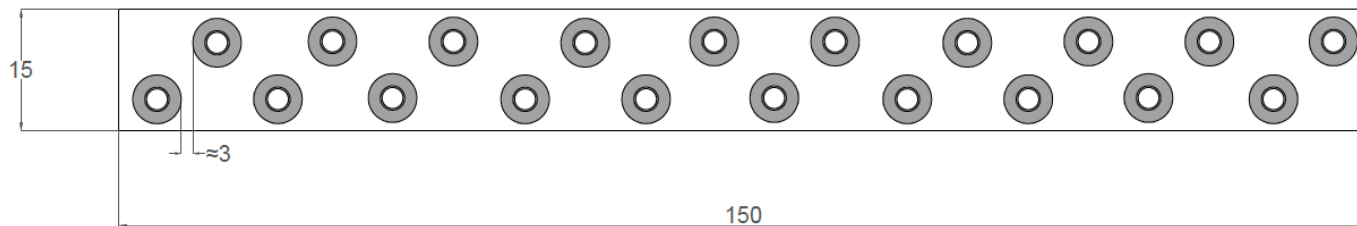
Disposición y distribución en planta de las estructuras alveolares. (Fuente: elaboración propia, 2023)
